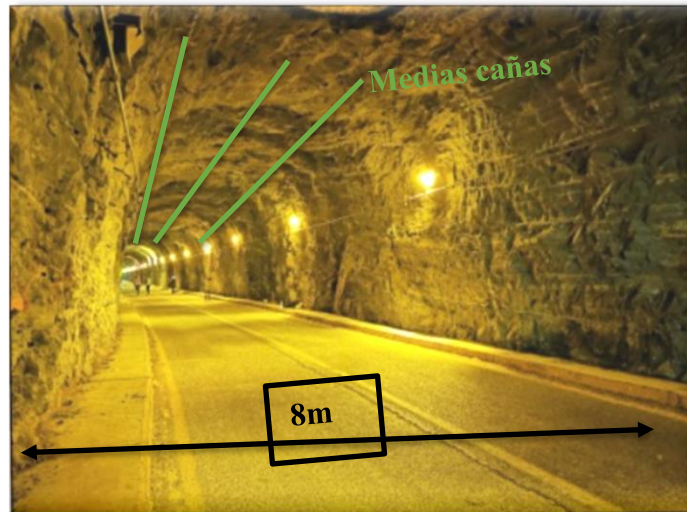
Interior del Túnel “La Mora”, en donde se aprecia la geometría tipo portal y las dimensiones de la excavación.
